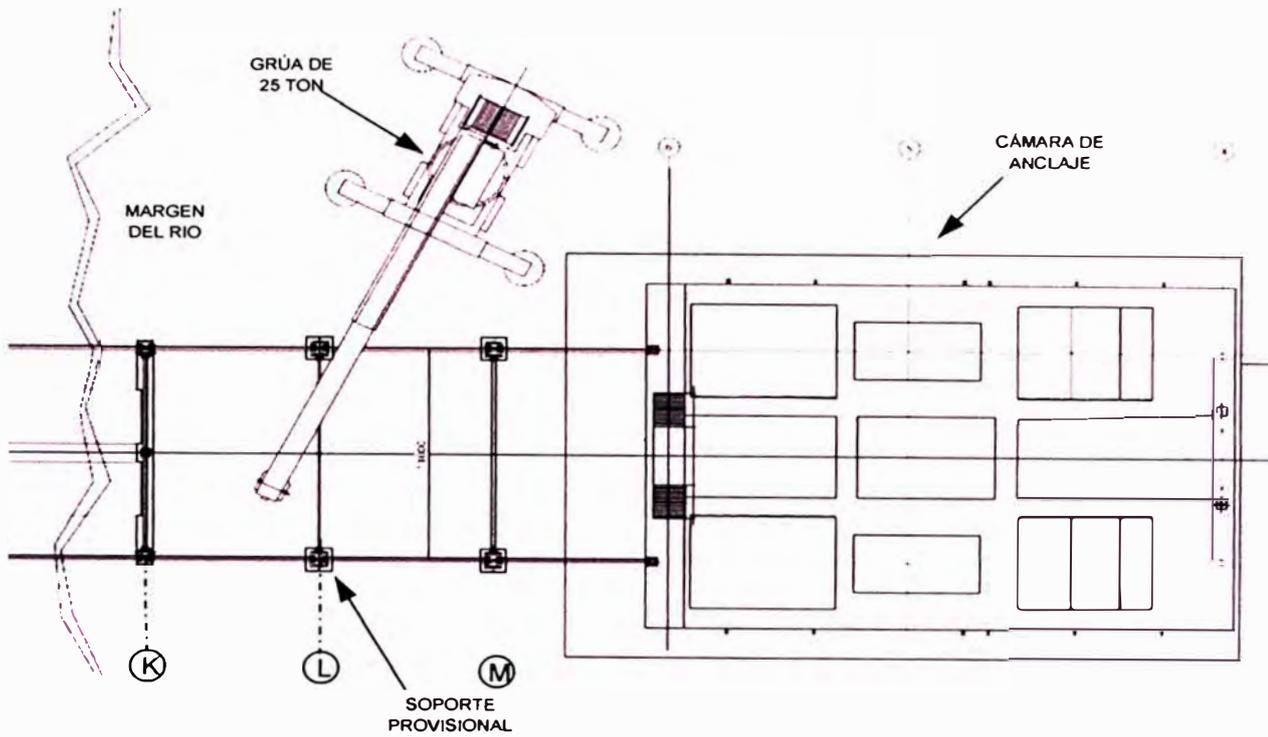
VISTA DE PLANTA DEL MONTAJE DE COLUMNAS EN LOS
